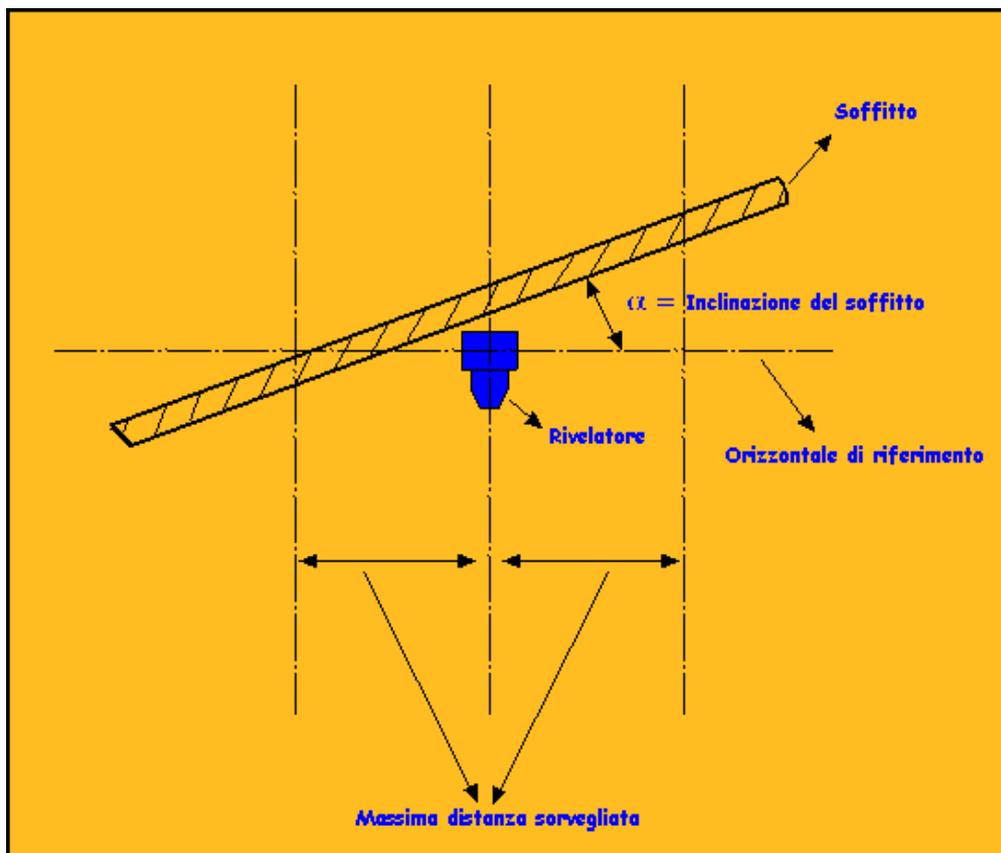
Prospetto per la comprensione delle tabelle 1, 2, 4 e 5
